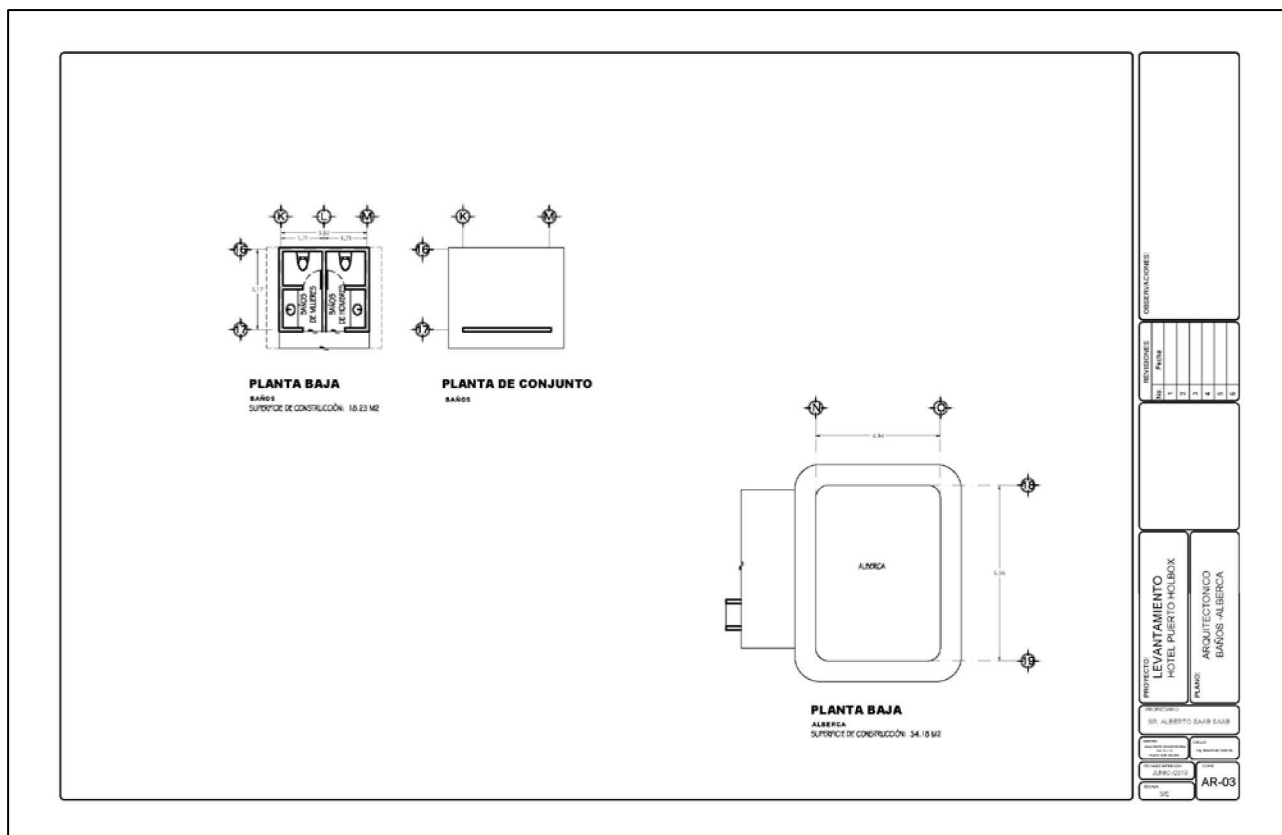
Plano planta baja baños y alberca, correspondientes a la construcción 7
